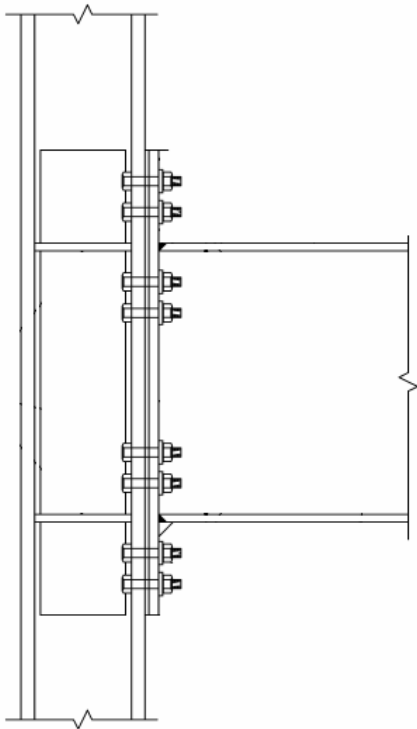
d. Assemblage par platines d'à bout raidies soudées à la poutre et boulonnées à l'aile du poteau par 8 rangées de boulons.
